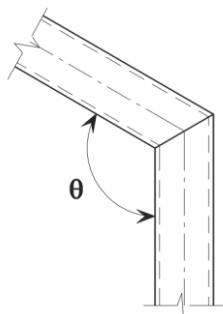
JUNTA SOLDADA EM COTOVELO
